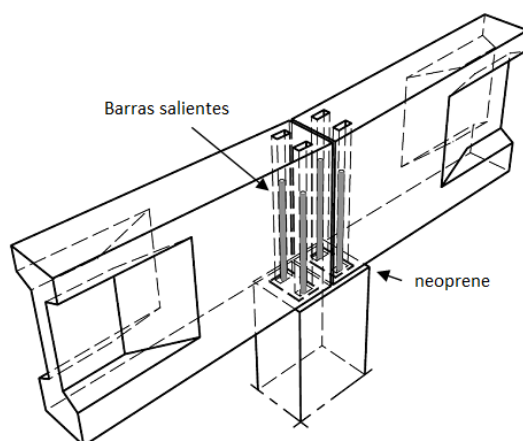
Ligação viga-pilar. Adaptado: Fib (2014).
